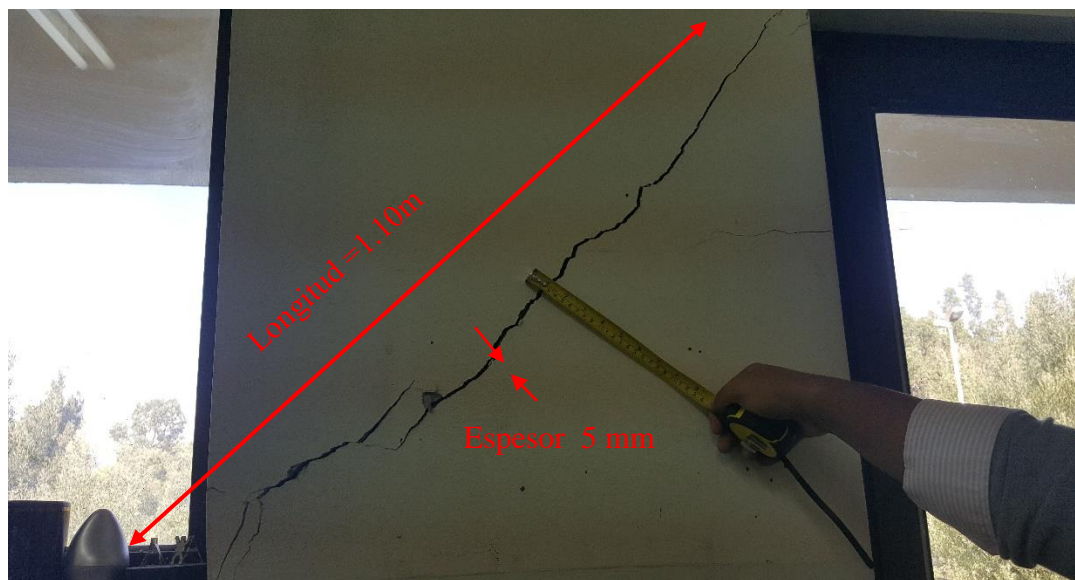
Grieta en mampostería, Planta alta eje 1 entre C y D
